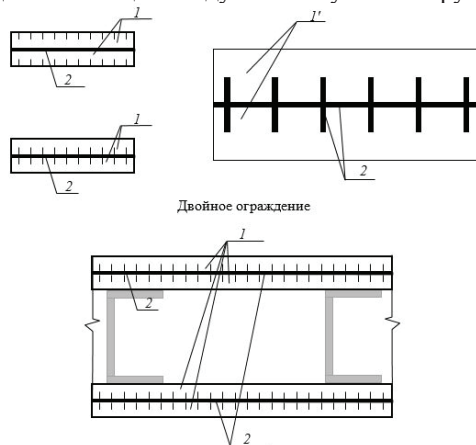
Конструкции из вибродемпфированных элементов: 1 – наружный слой (ГВЛ, ГКЛ, фанера, ЦСП и т. д.); 1' – наружный слой (бетон, газобетон, пенобетон и т. д.); 2 – вибродемпфирующий материал
